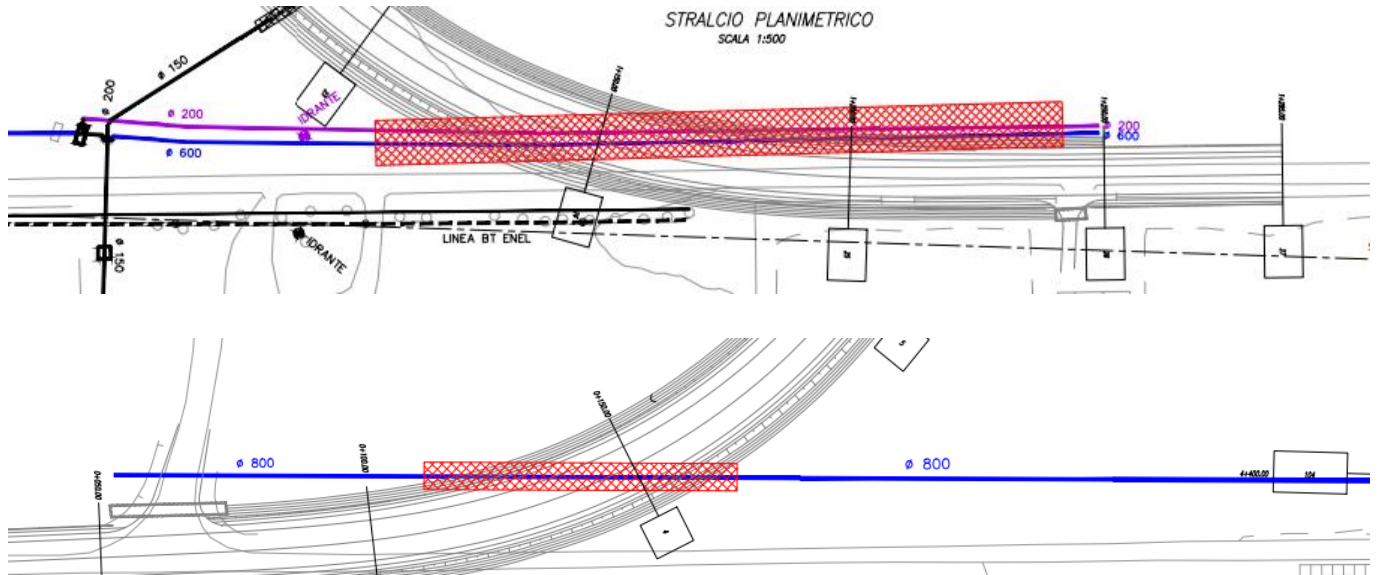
Stralci planimetrici con indicazione dei tubi di protezione al di sotto NV01.
